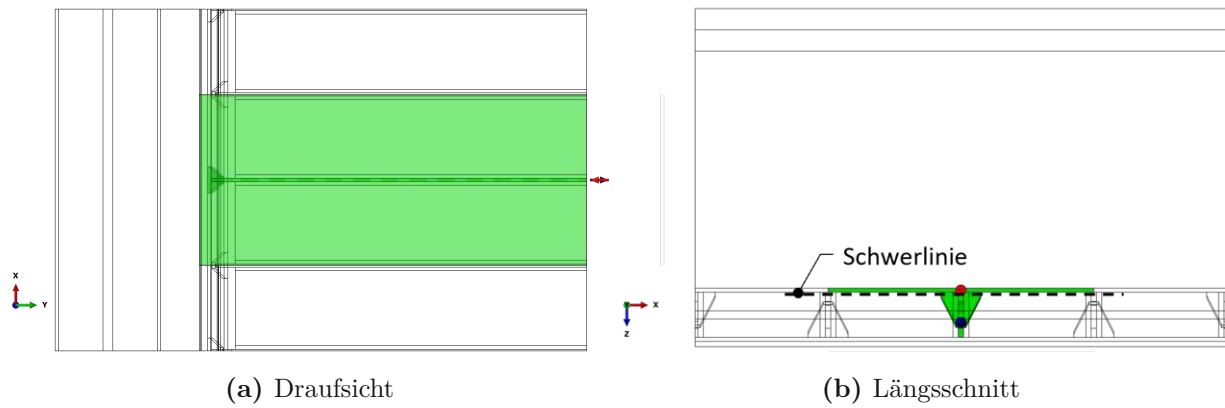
Tragwirkung T-Querschnitt oben: (a) Draufsicht (b) Längsschnitt
